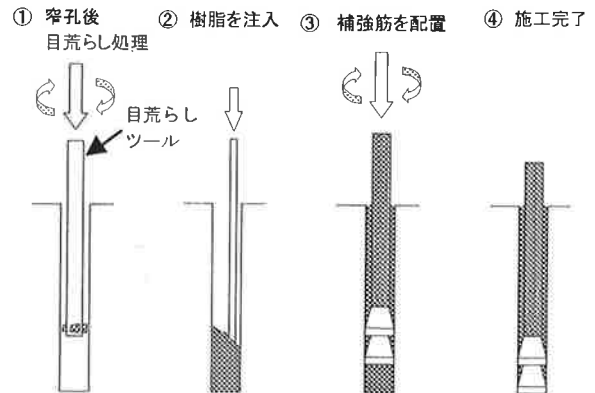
補強筋のみ及びテーパコーンタイプのアンカーの施工
